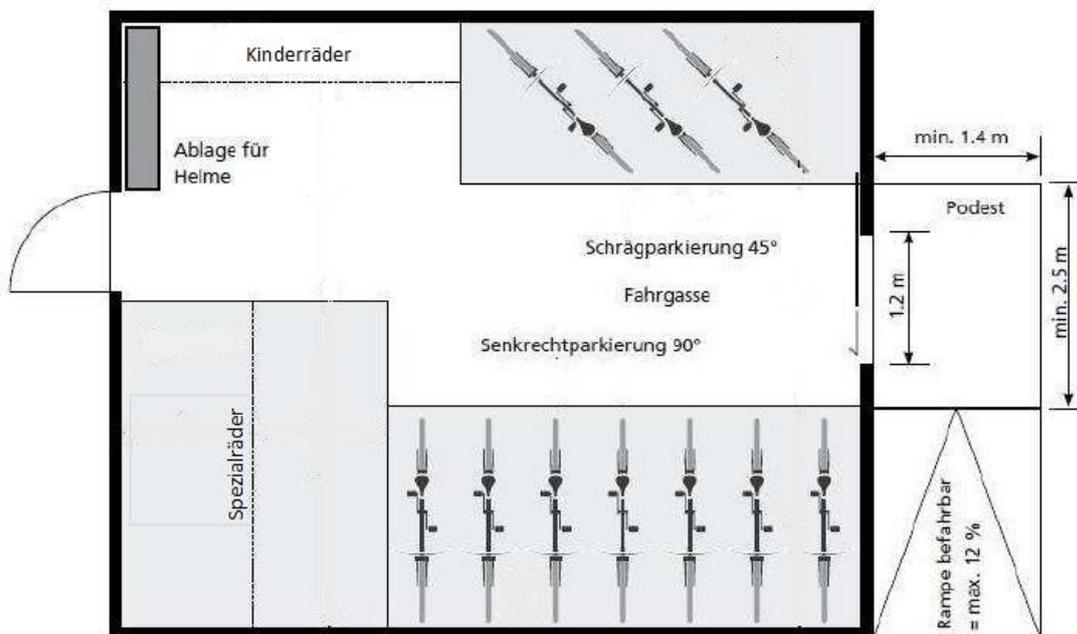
, Mustergrundriss eines Radabstellraumes (Sigrist D., et al., 2008)
